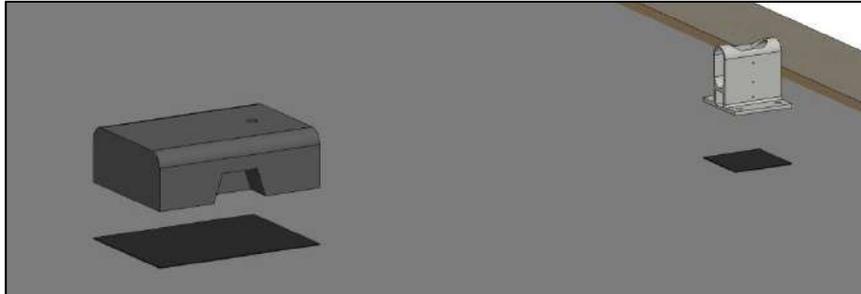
Posicionamiento del pie de montante y contrapeso sobre junta de estanqueidad para parapeto autoportante.
